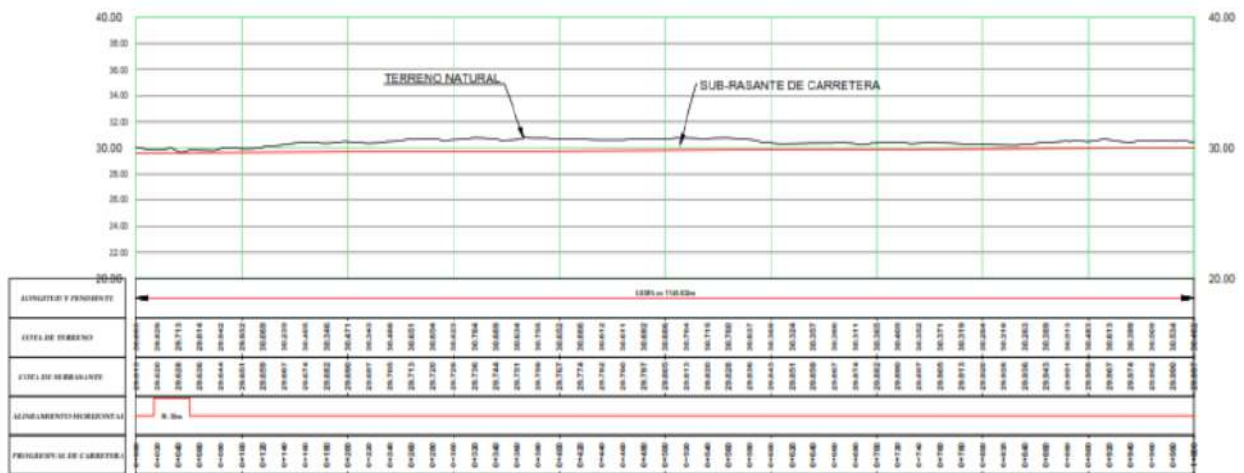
Perfil Longitudinal con rasante y terreno natural, 2021.
